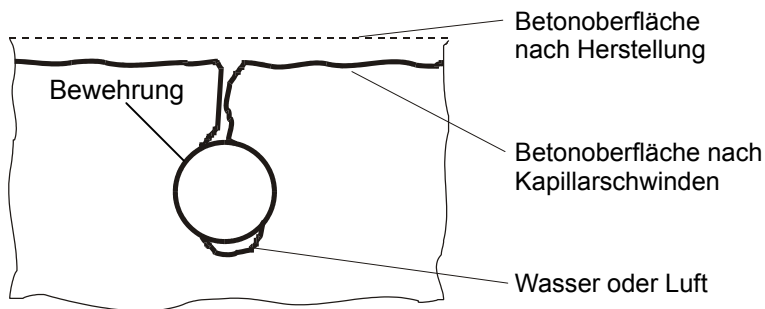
Rissbildung über einem Bewehrungsstahl infolge Blutens und Kapillarschwindens, aus Grube (1991)
